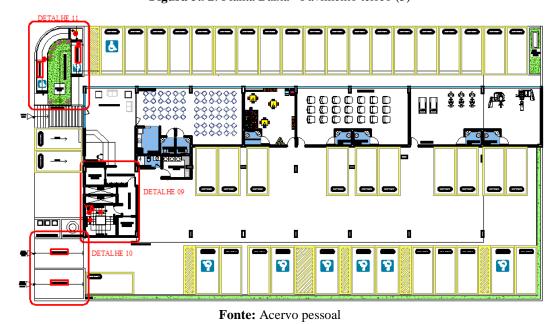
Planta Baixa - Pavimento térreo (3)
